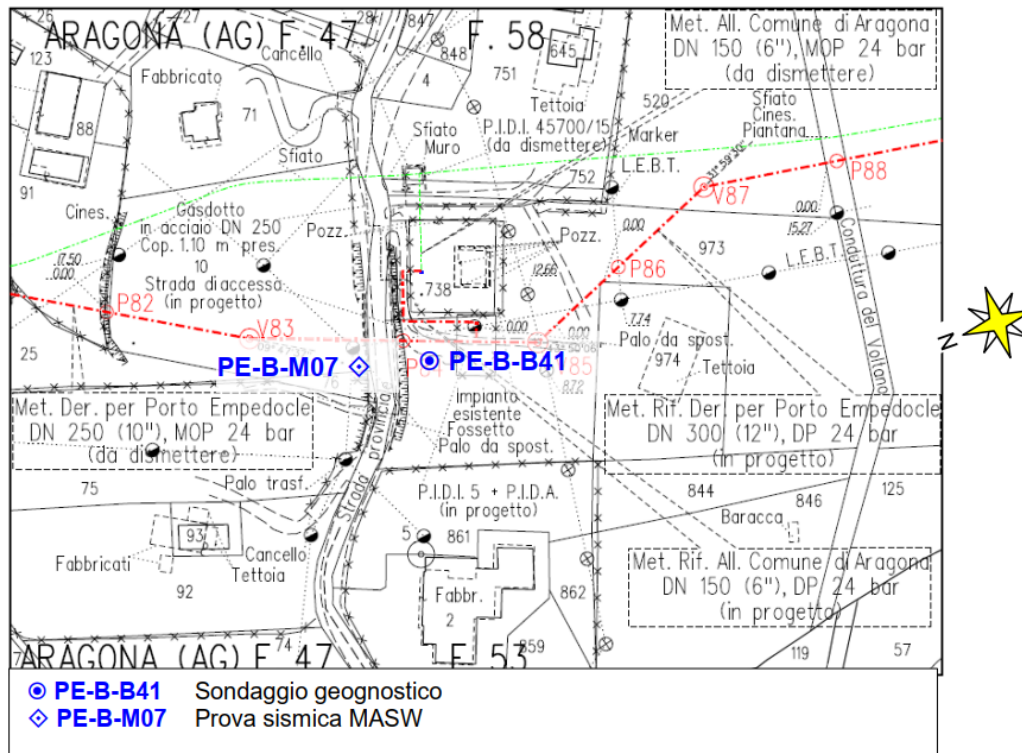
Planimetria catastale con ubicazione delle prove in sito
